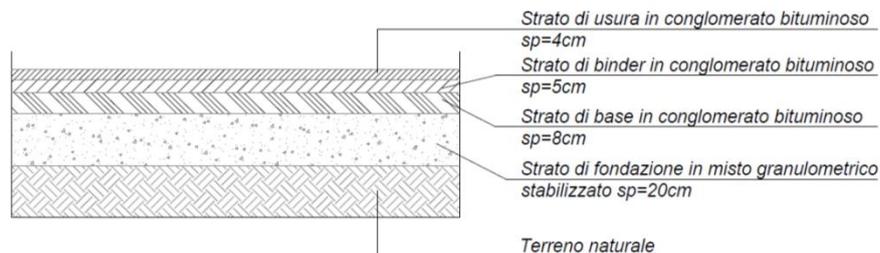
Pacchetto stradale, viabilità SL01 e SL02
